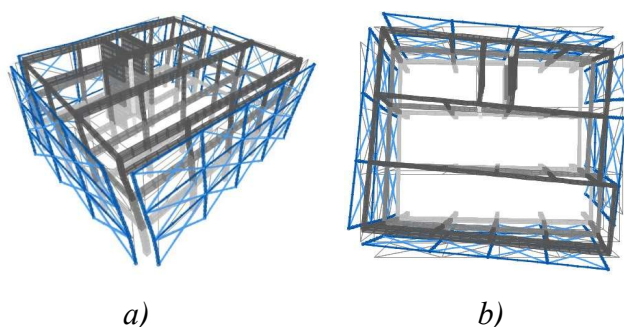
Deformate modali del terzo modo di vibrare: a) vista prospettica 3D, b) vista prospettica dall'alto
